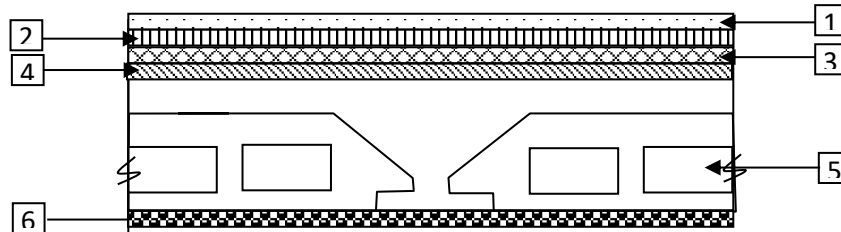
Coupe transversale d'un plancher terrasse inaccessible
